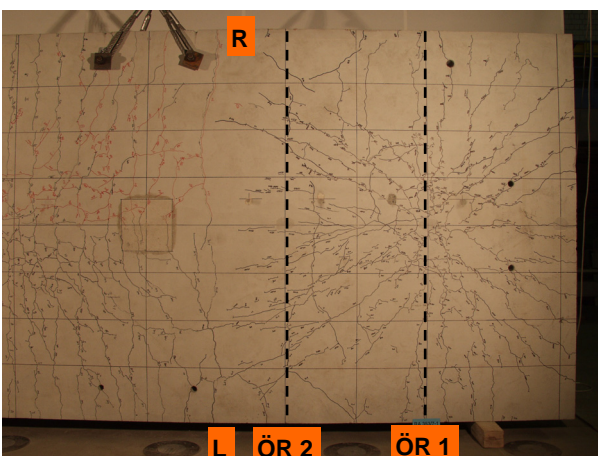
Rissbild auf der Betongurtoberseite
